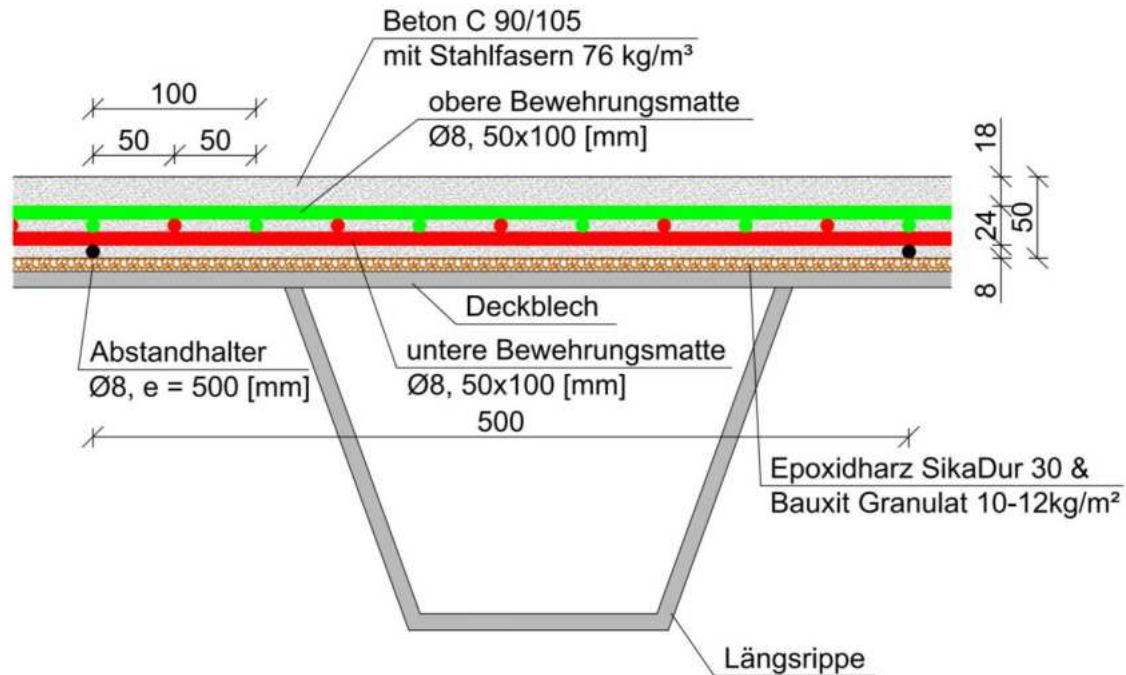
Bewehrungsführung „Typ I“ für System "ferroplan", Aufbau aus [3]
